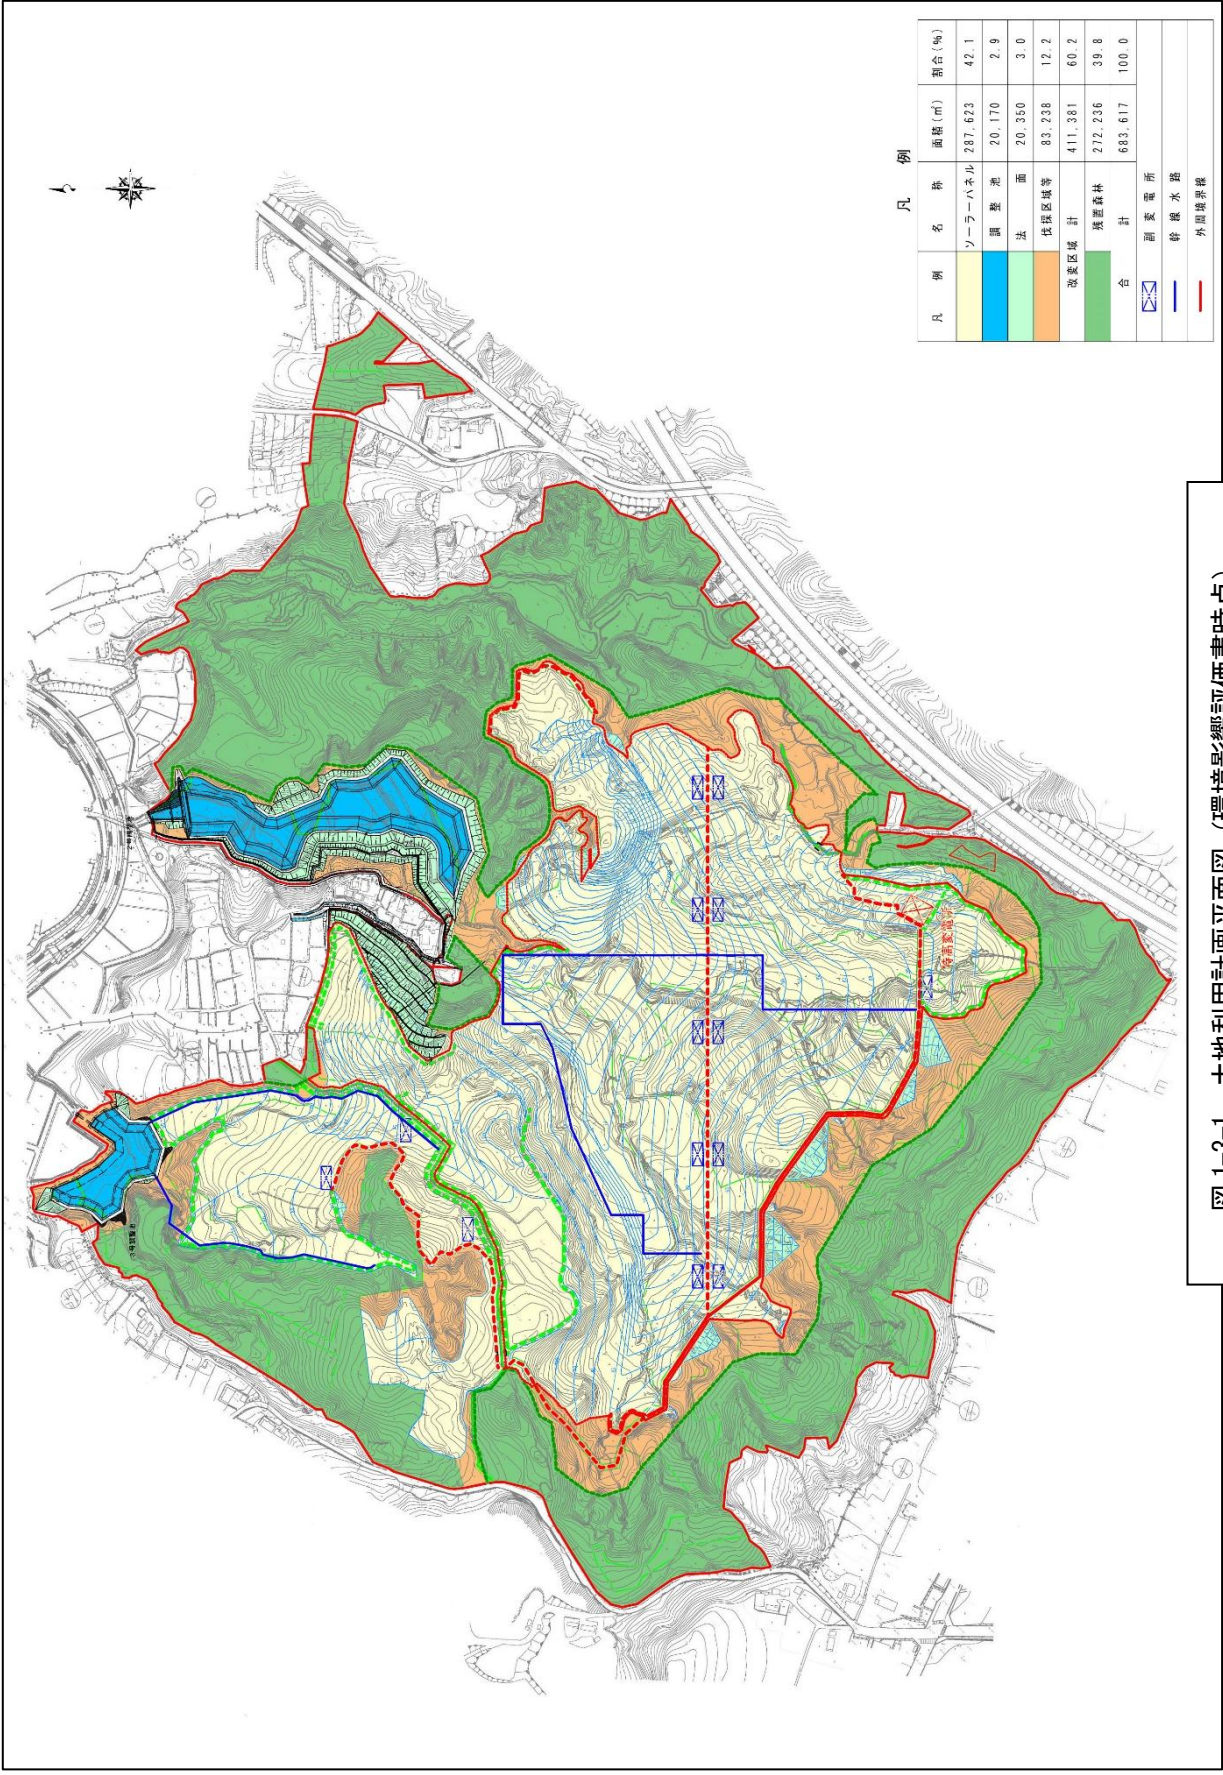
土地利用計画平面図（環境影響評価書時点）
